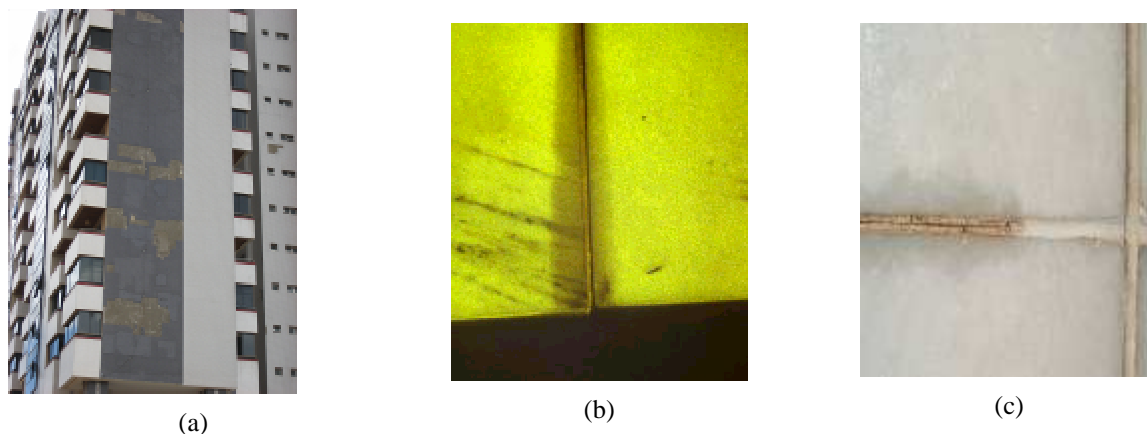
(a) Perda de aderência do revestimento cerâmico, (b) manchamento do revestimento, (c) fissuração da junta.
